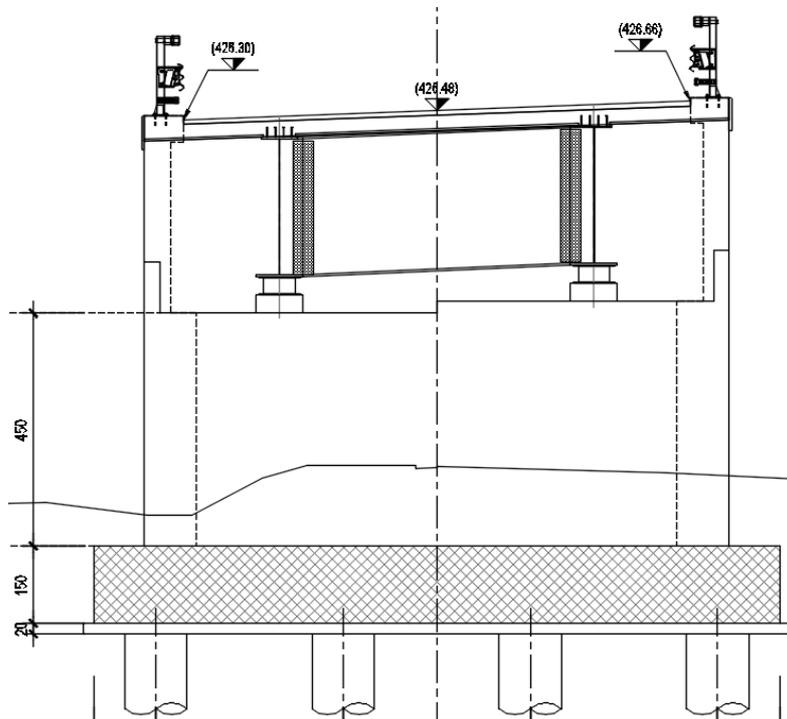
Viadotto Firenzuola – Sezione su spalla
